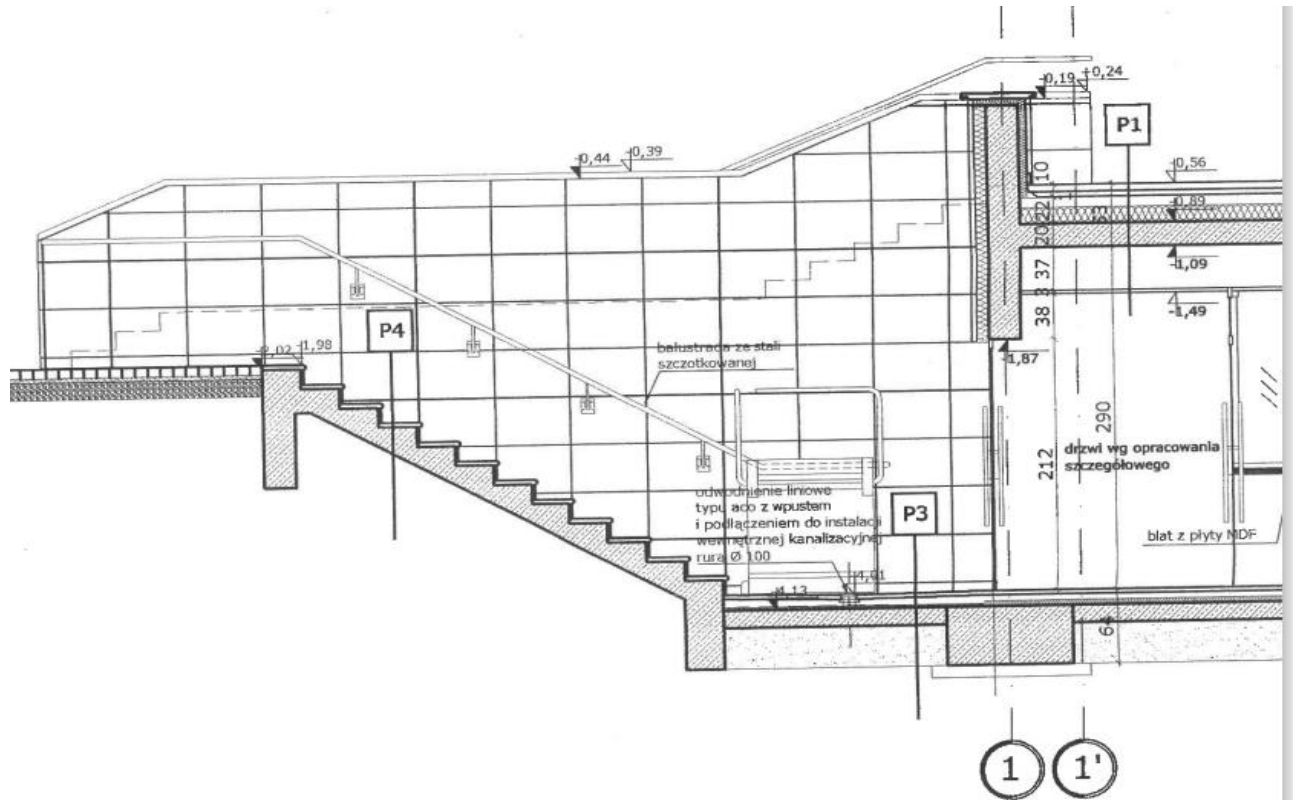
,lokalizacja elementów będących przedmiotem zamówienia
